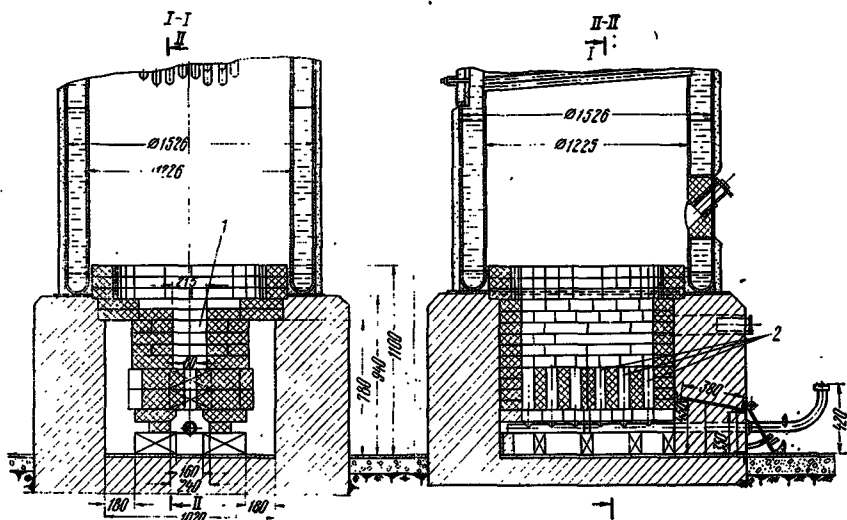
Расположение подовой щелевой горелки под вертикально-цилиндрическим котлом
